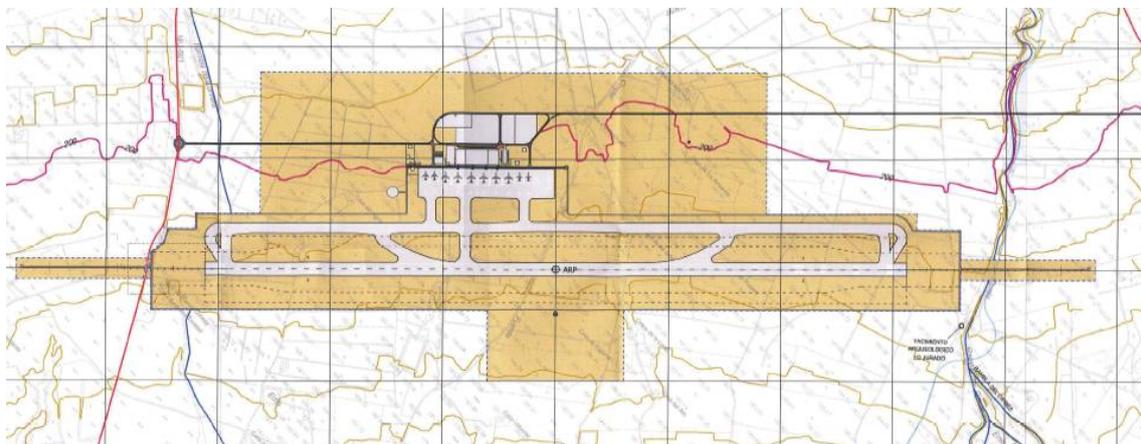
Plano de necesidades de terreno según el Plan Director. Fuente: Ministerio de Fomento. [6]
